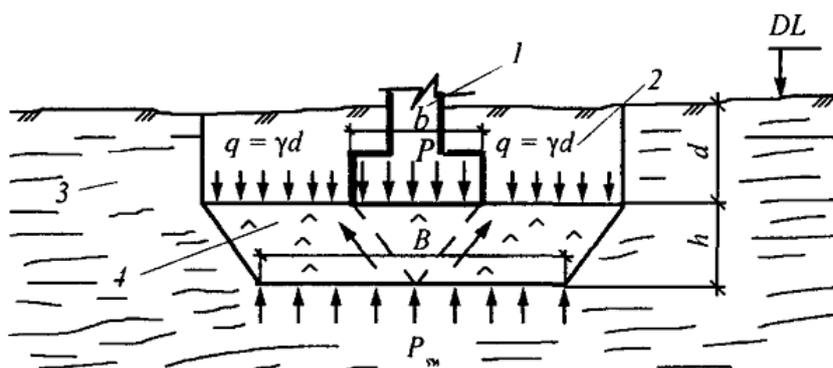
Схема сил, действующих на компенсирующую подушку: 1 – фундамент; 2 – обратная засыпка; 3 – набухающий грунт; 4 – песчаная компенсирующая подушка
